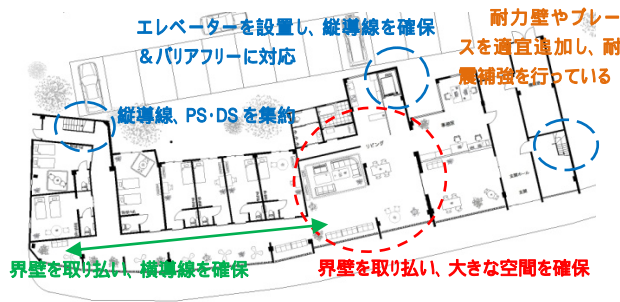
改修後の平面図の一例（想定機能は小規模多機能ホーム）
